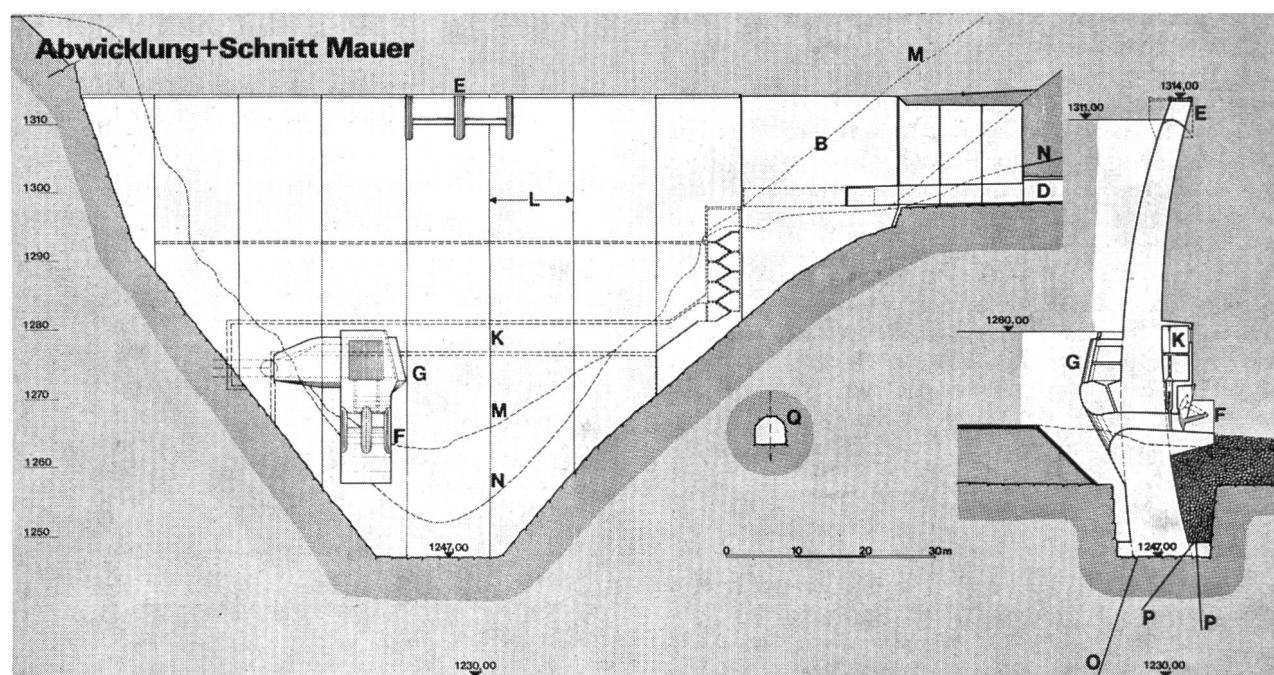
und 9 Lageplan, Abwicklung und Querschnitt der doppelt gekrümmten Bogenstaumauer Ferden.
